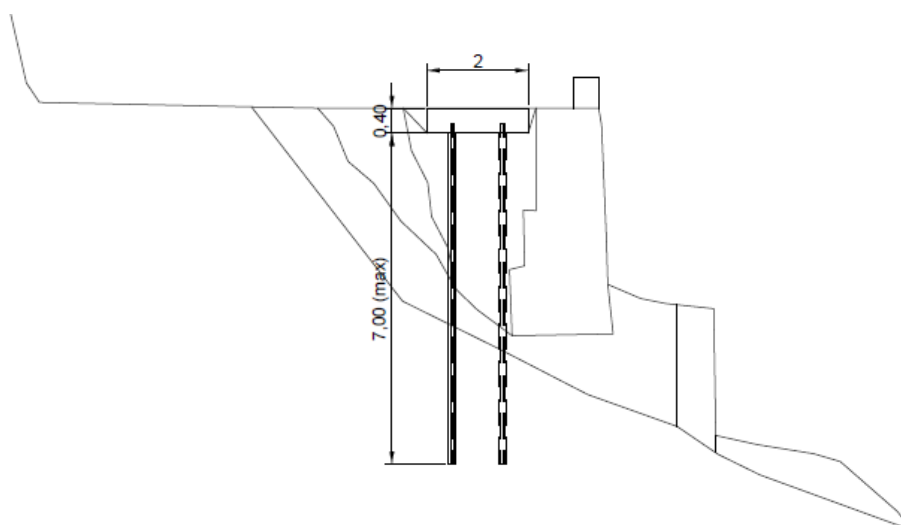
Croquis en alzado de la solución de cimentación profunda de los apoyos de la grúa.
